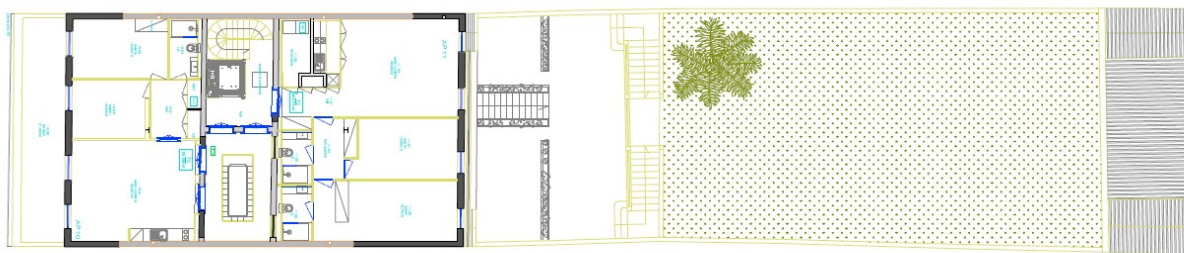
Planta de proposta de intervenção do piso 3 (sem escala)
